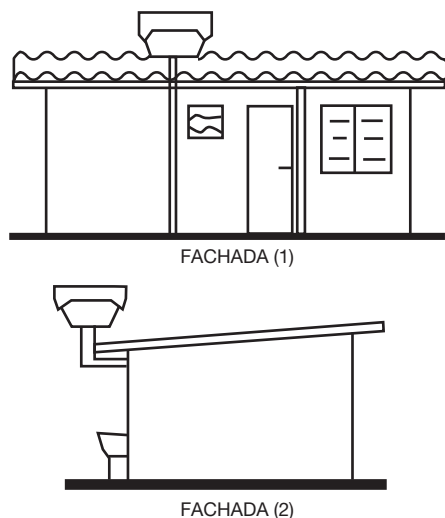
FACHADAS LONGITUDINAL E TRANSVERSAL DO EMBRIÃO DE 24M2
